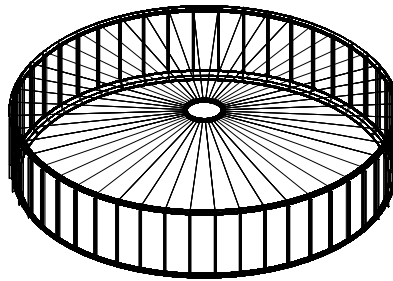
Конструктивна схема каркасу оболонкової конструкції циліндричного резервуару з висячим покриттям з тонколистової оболонки
